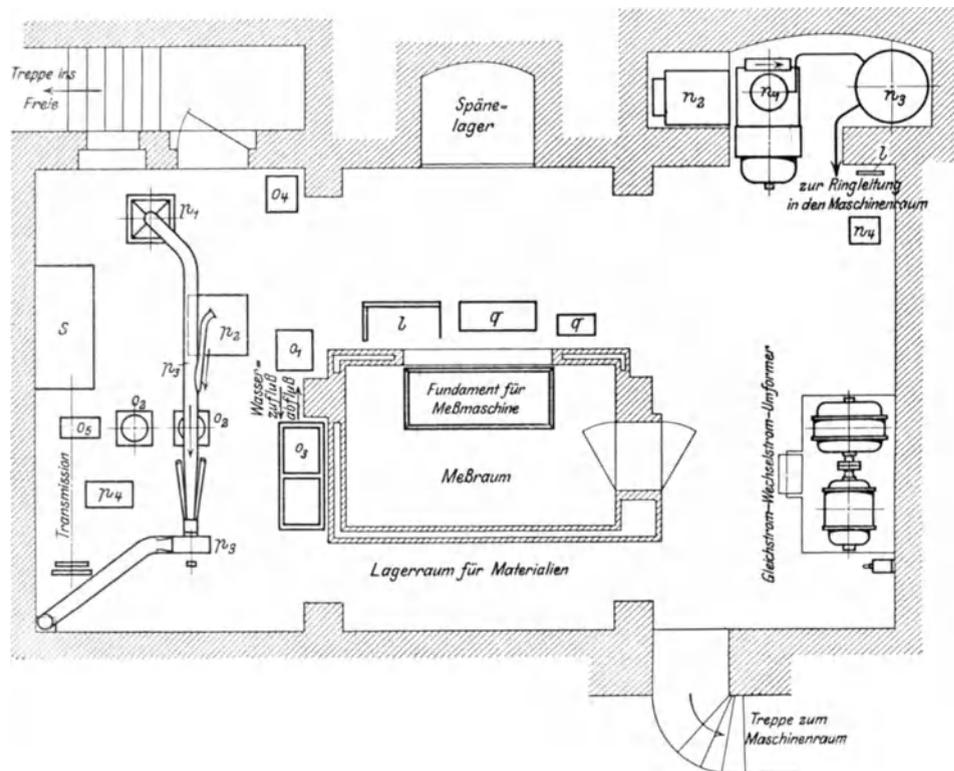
Versuchsfeld für Werkzeugmaschinen. Grundriß des Kellers.
